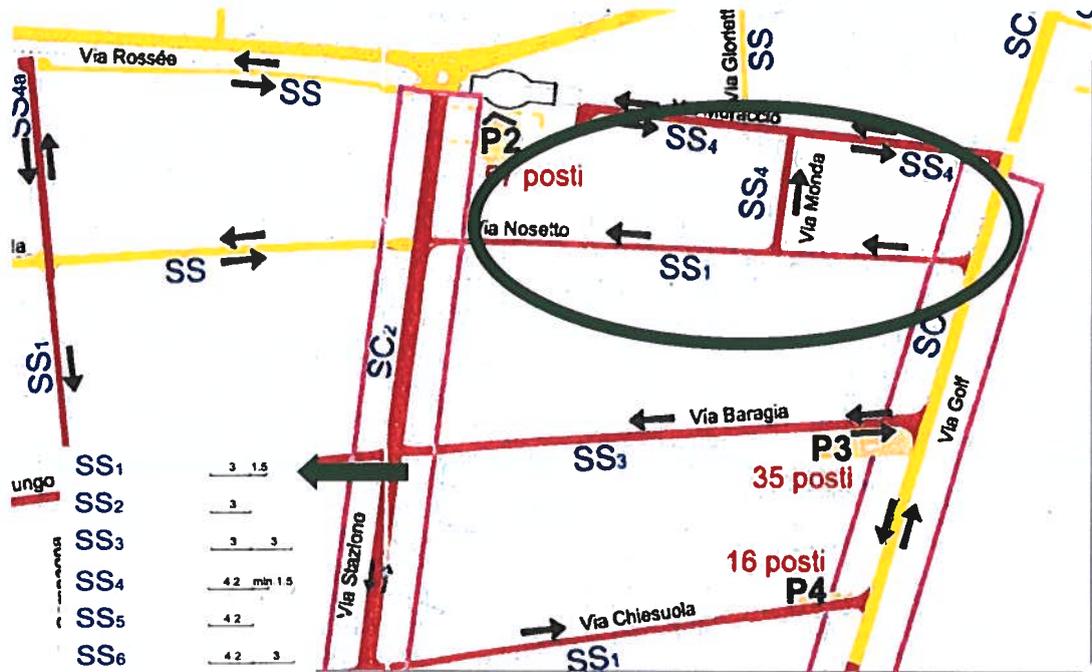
Estratto planimetrico dal Piano Viario di Caslano - Identificazione calibro di Via Nosetto
